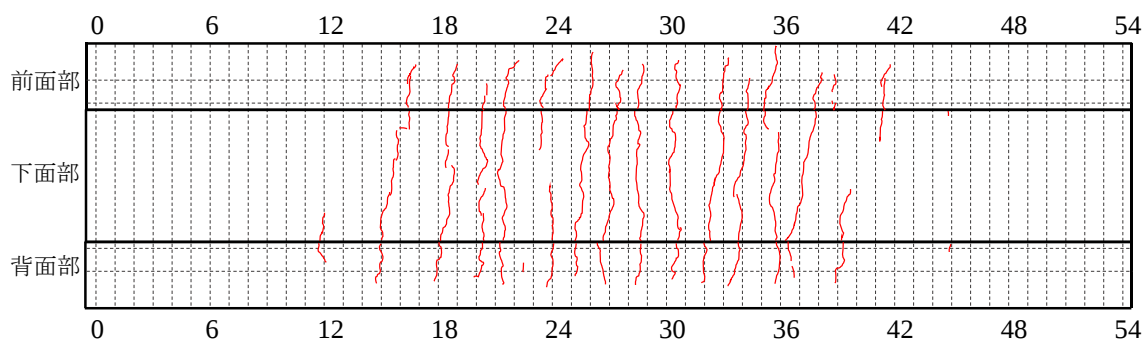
RC 梁試験体の可視ひび割れ展開図
